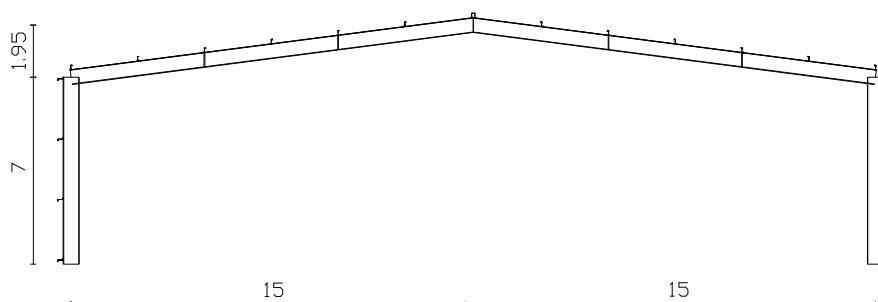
Pórtico rígido viga e pilar de alma cheia, vão de 30.00m
